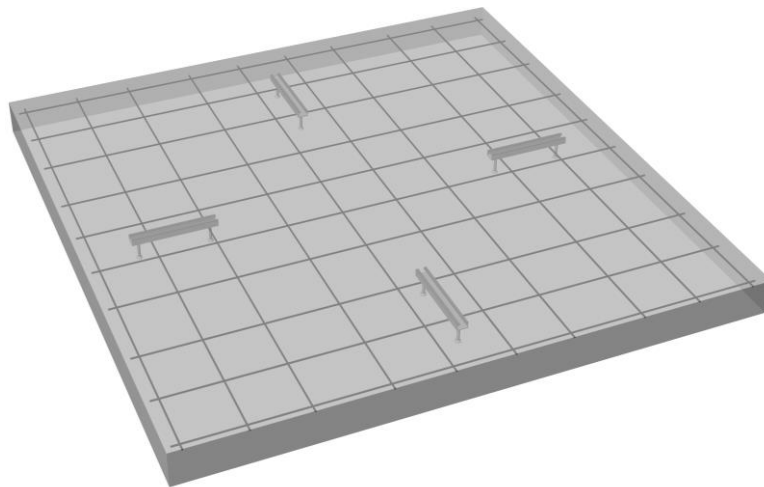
Versuchskörper B2 mit Oberflächenbewehrung
